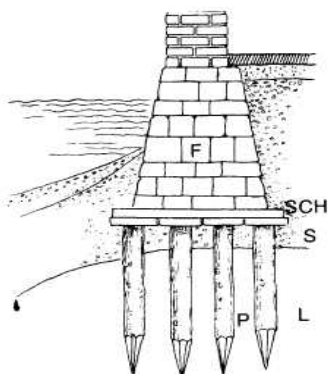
Закладка фундамента на дне лагуны. Сваи Р, забитые в слой песка S и глины L и закрытые сверху решеткой из толстых досок Sch; поверх уложен фундамент F из камней, привезенных с полуострова Истрия. Выше зеркала воды – кирпичная стена
